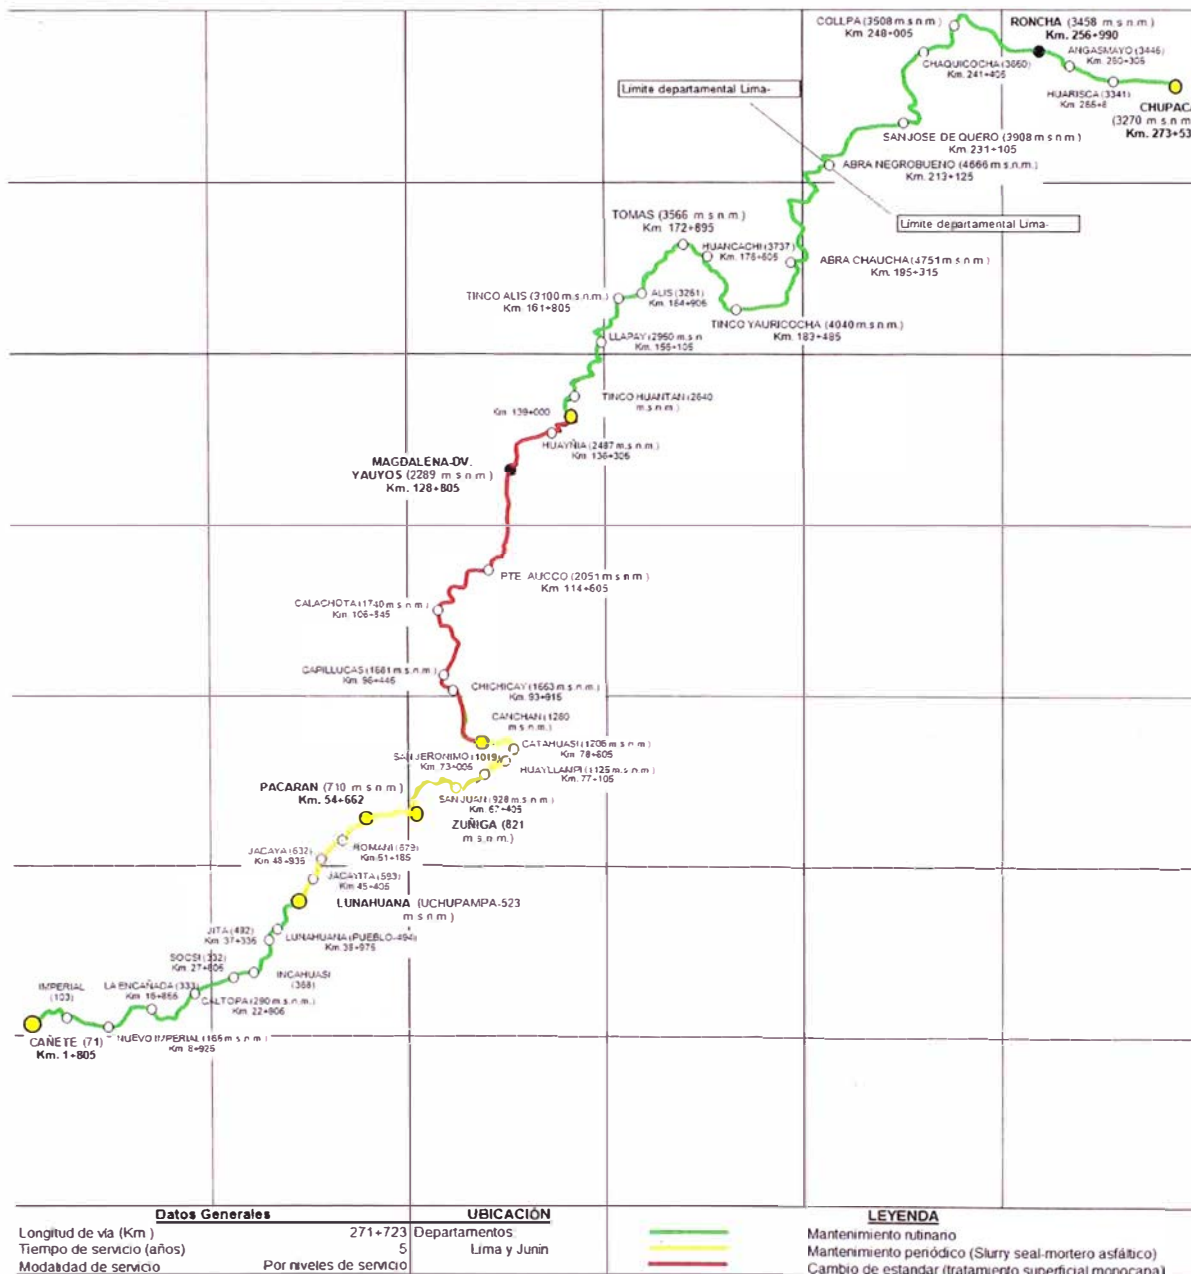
PLANO CLAVE DE LA RUTA 22
